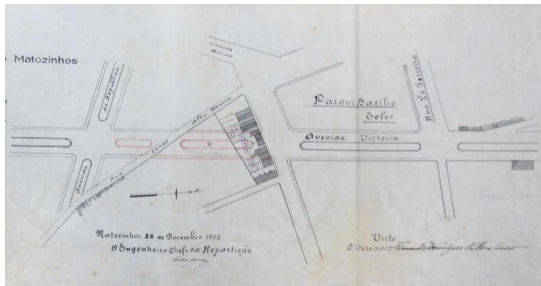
Detalhe da Planta de Reformulação da avenida Vitória – proposta de 1936.
